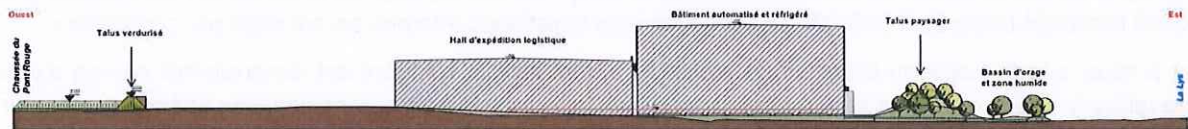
Profil ouest-est du site projeté (source : Bureau d'architectes Jan Claeyts)
